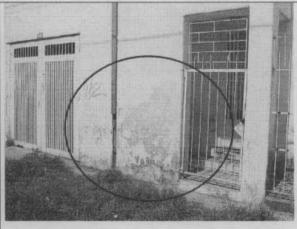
Desprendimiento de acabados en fachada a nivel de primer piso.
